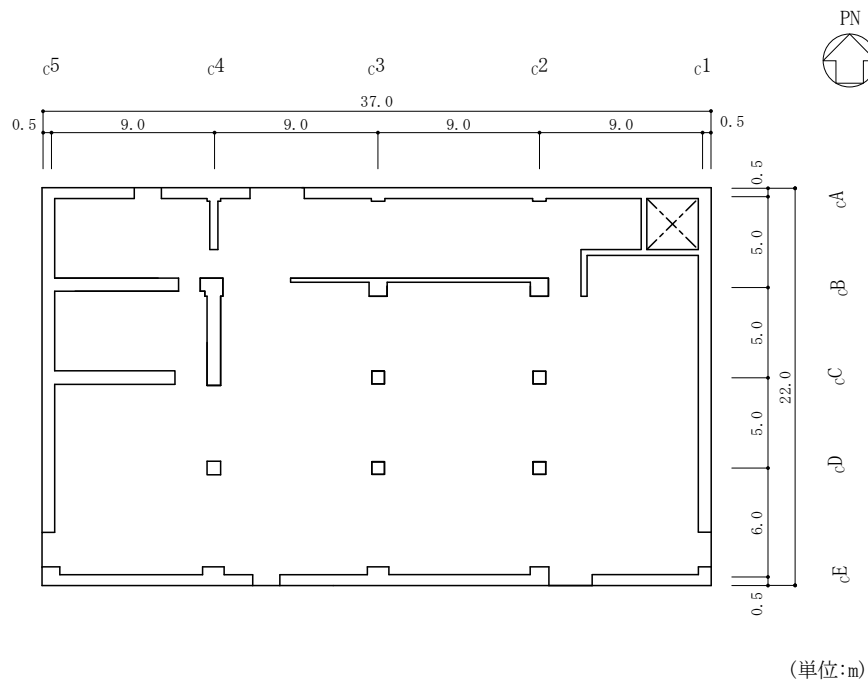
(2) 制御室建物の概略平面図 (EL 8.8m)
